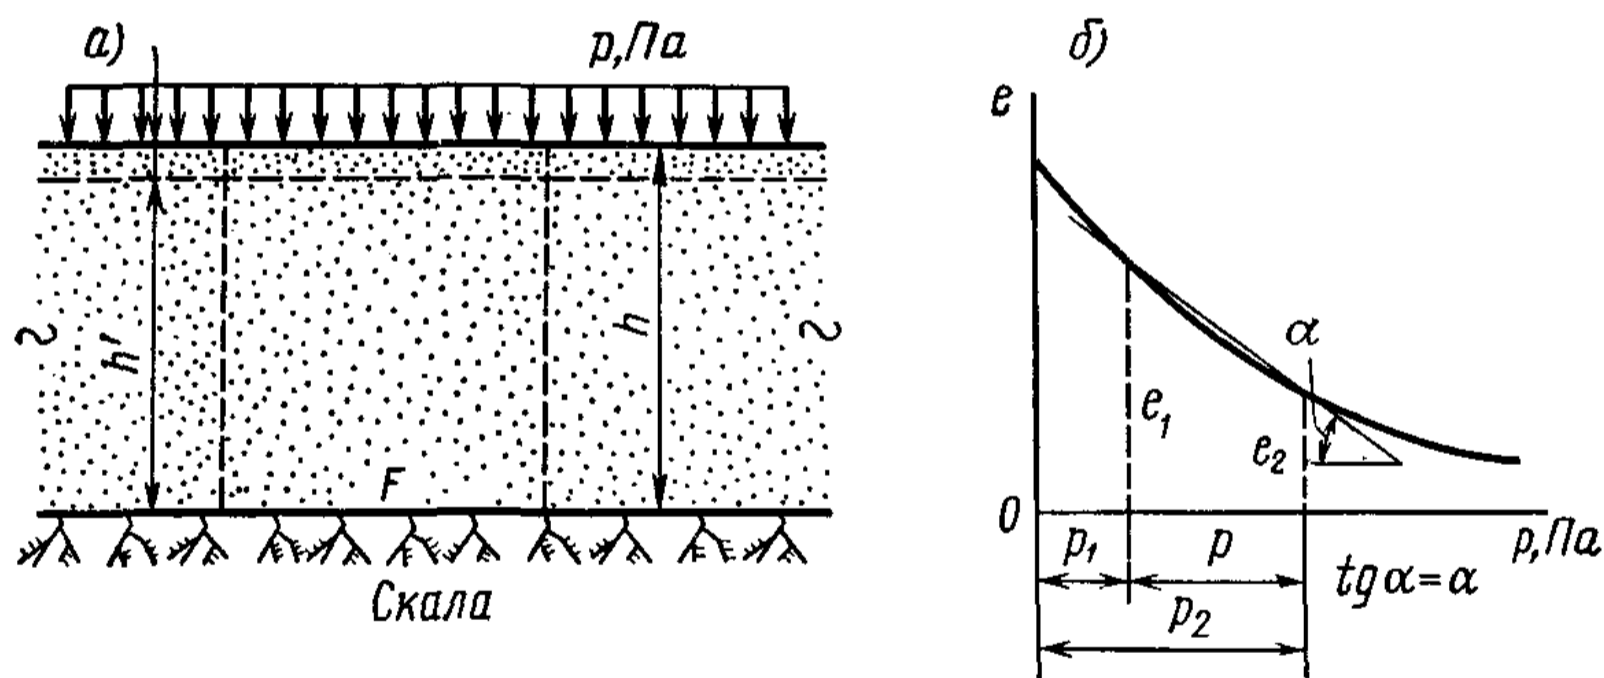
Схема сжатия слоя грунта при сплошной нагрузке:
